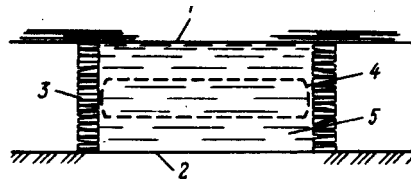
Закладка кровли выработки Йоркширского угольного месторождения с армированием проволочной сеткой
